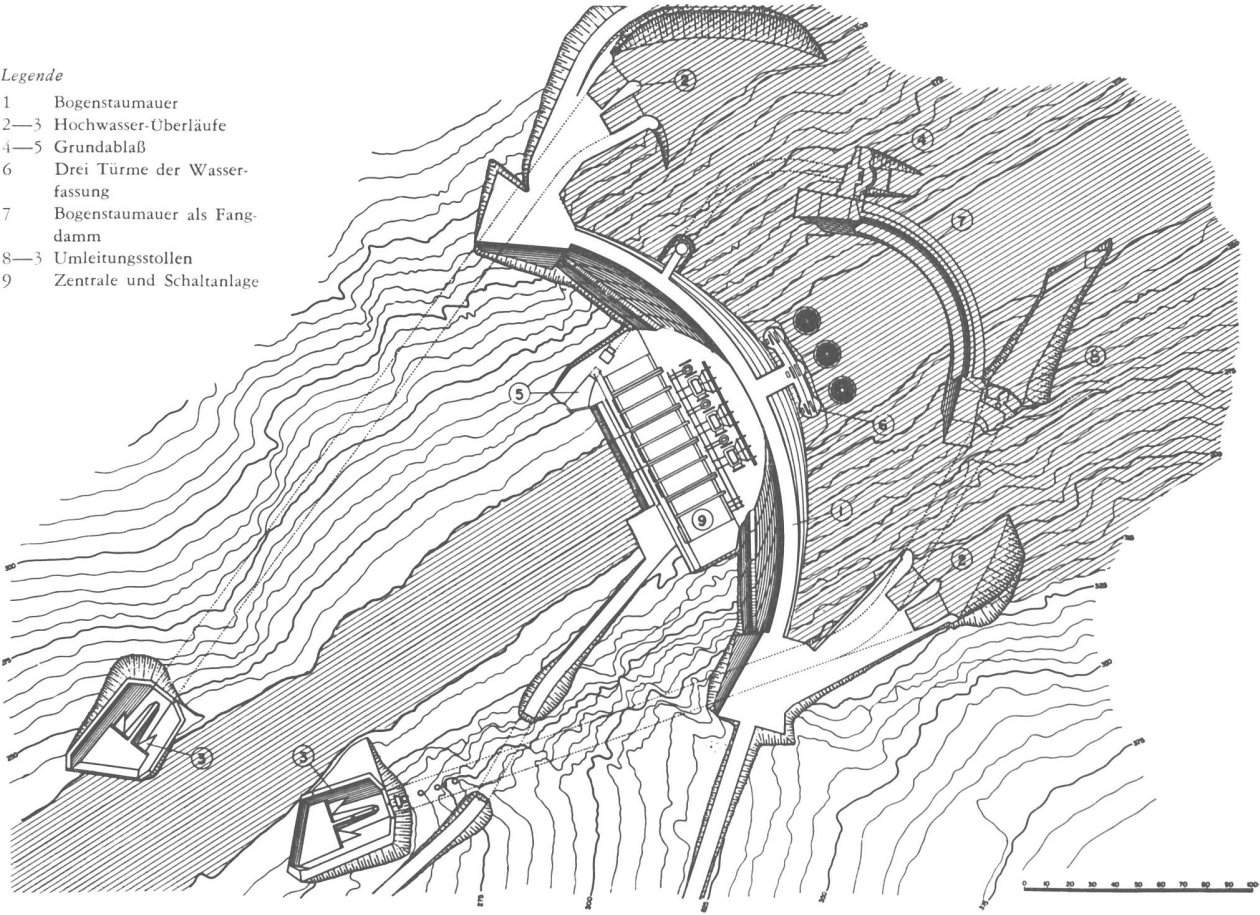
Lageplan von Bogenstaumauer und Zentrale Valdecañas am Tajo
